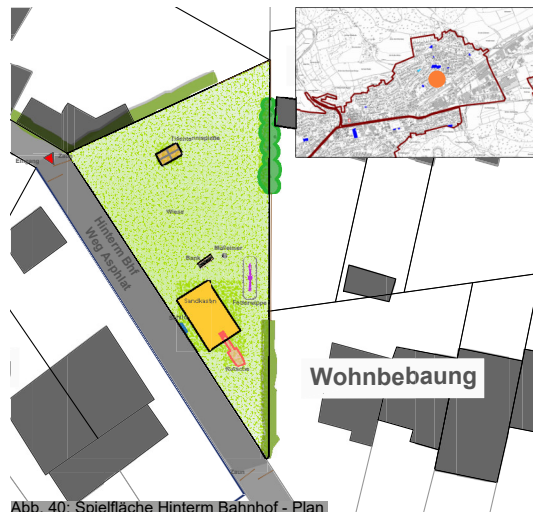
Spielfläche Hinterm Bahnhof - Plan
